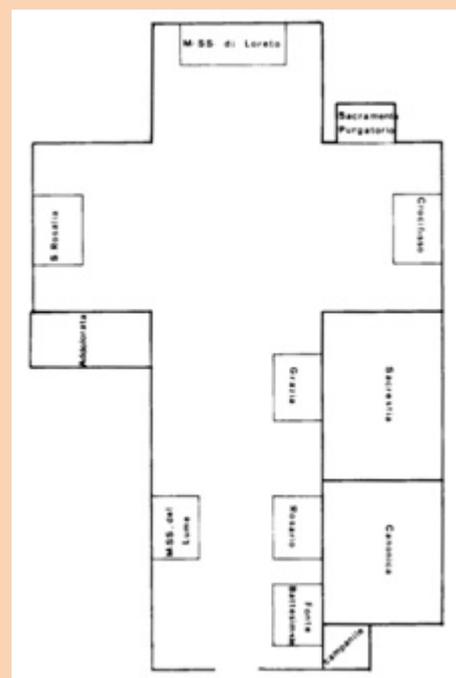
schema planimetrico della chiesa S. Maria di Loreto di Delia nel 1838
